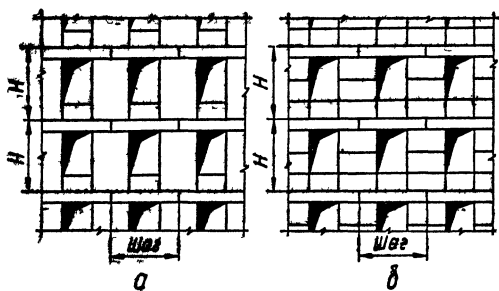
Разрезка стены (раскладки блоков): а — двухрядная при кладке из бетонных блоков; б — трехрядная при кладке из кирпичных блоков.
